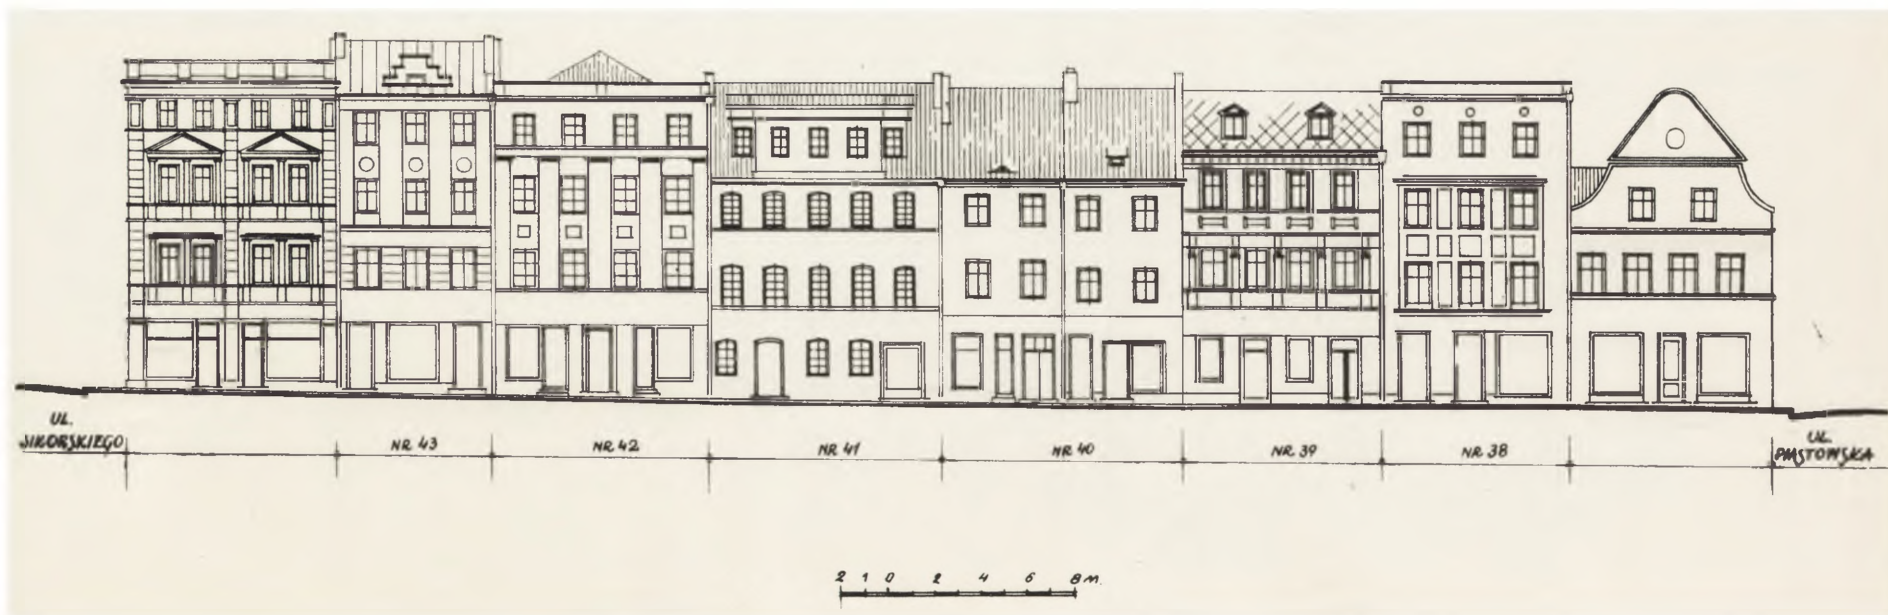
Paczków, inwentaryzacja pld.-wsch. pierzei rynku I (rys. Politechnika Walszawska, ZAP)
